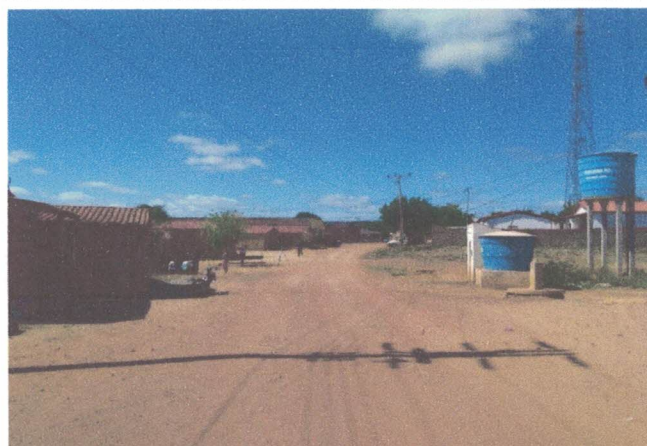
RUA PROJETADA - TRECHO 2
